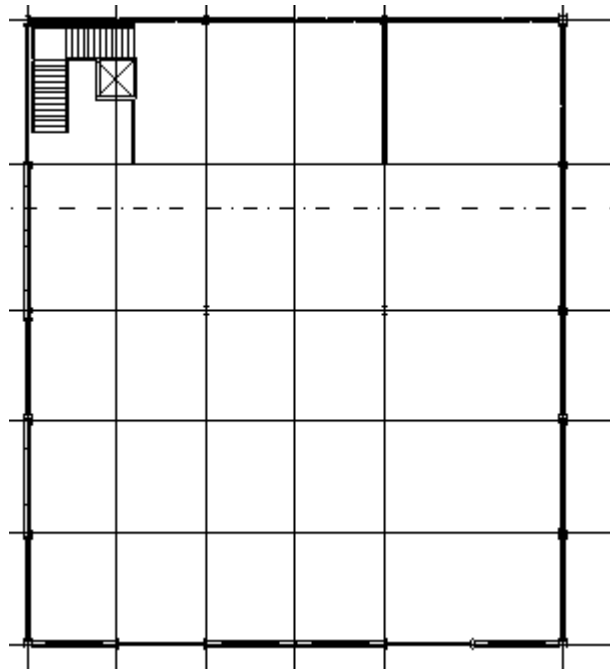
Espacio en bruto destinado a alojar a la primera planta.
